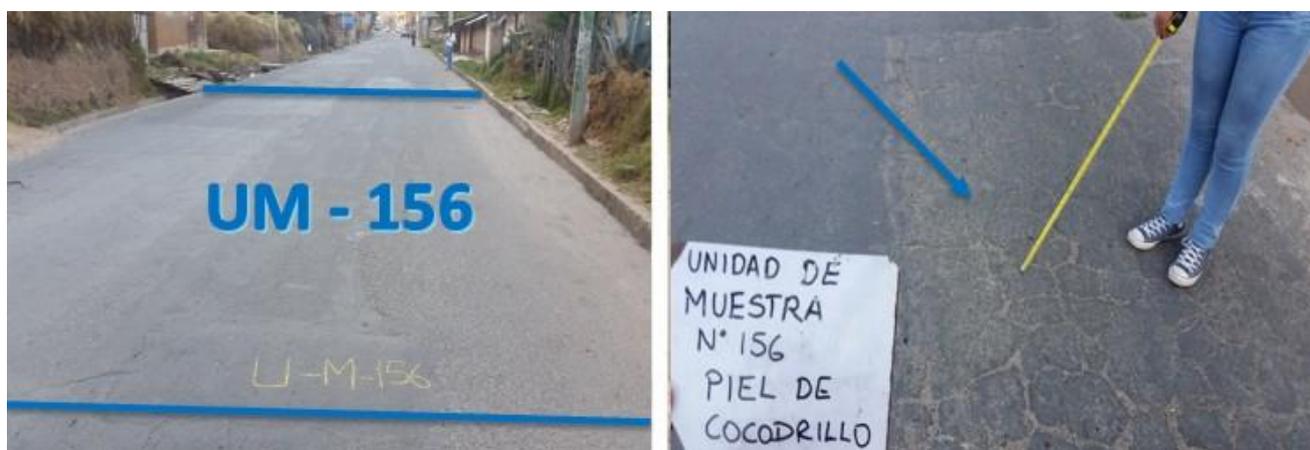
Unidad de Muestra N° 156: Dimensión – Falla en pavimento “Piel de Cocodrilo”
